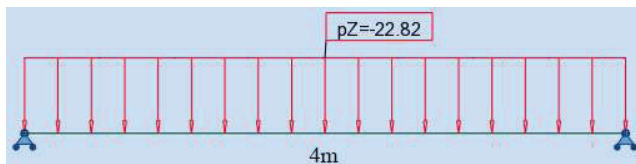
Schéma statique de la poutre de rive (1ère phase)
